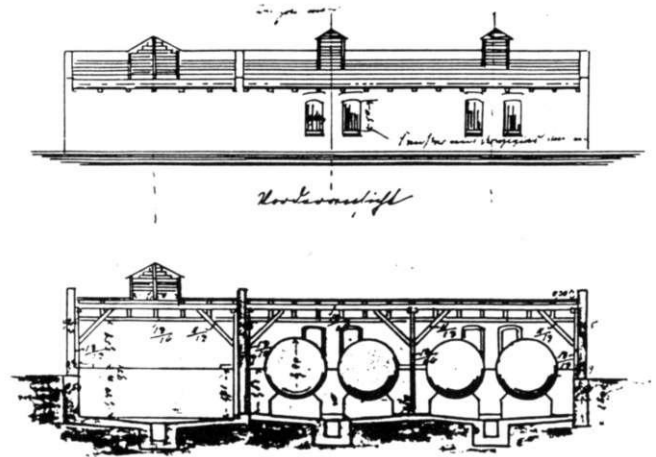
1886. Ein Gewächshaus an der Berliner Chaussee 48.
